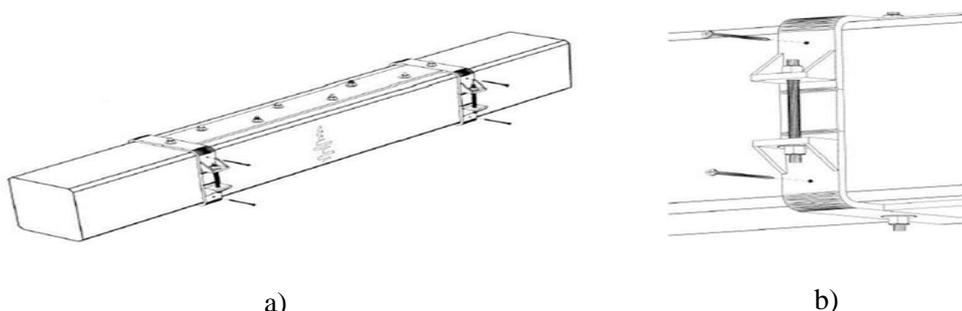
a) Reforço de viga através da colocação de cintas metálicas com chapas metálicas nas faces superior e inferior; b) Pormenor da ligação mecânica efetuada por cintas com aperto regulável (Mariani, 2004)
